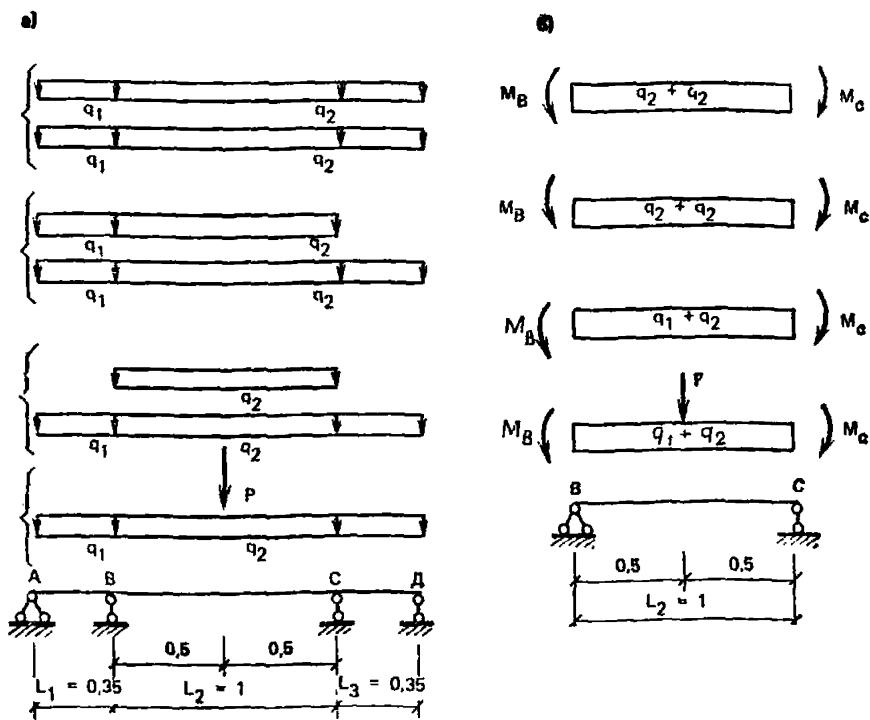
Расчетные схемы складки подвесного потолка при расчете в поперечном направлении
